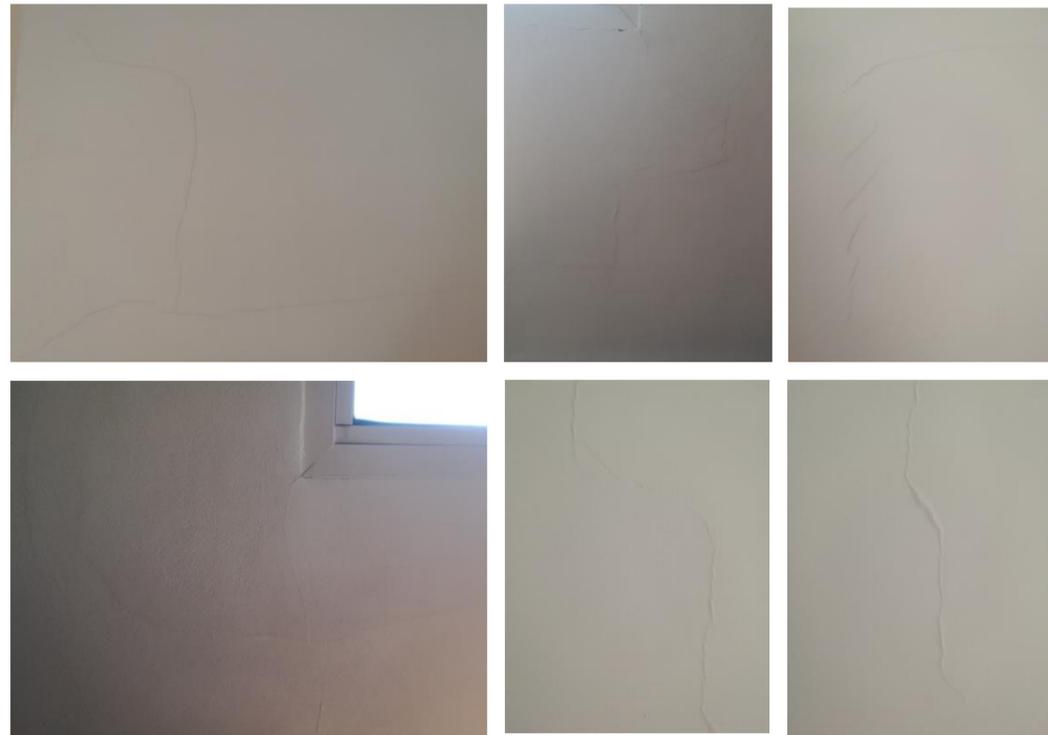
Fisuras pequeñas vivienda 3 planta primera. 2018. Elaboración propia
